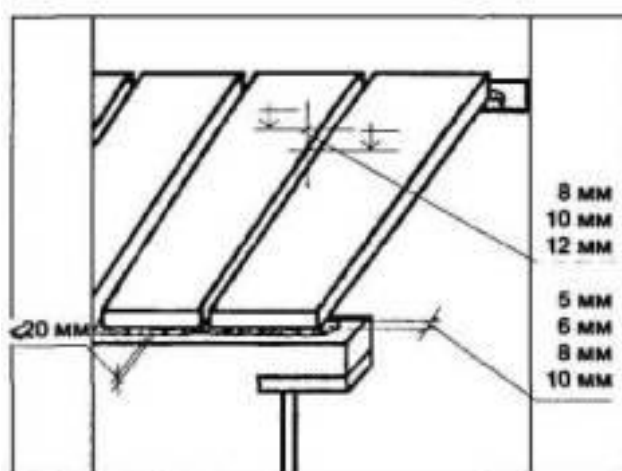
Схема допускаемых отклонений плит покрытий
